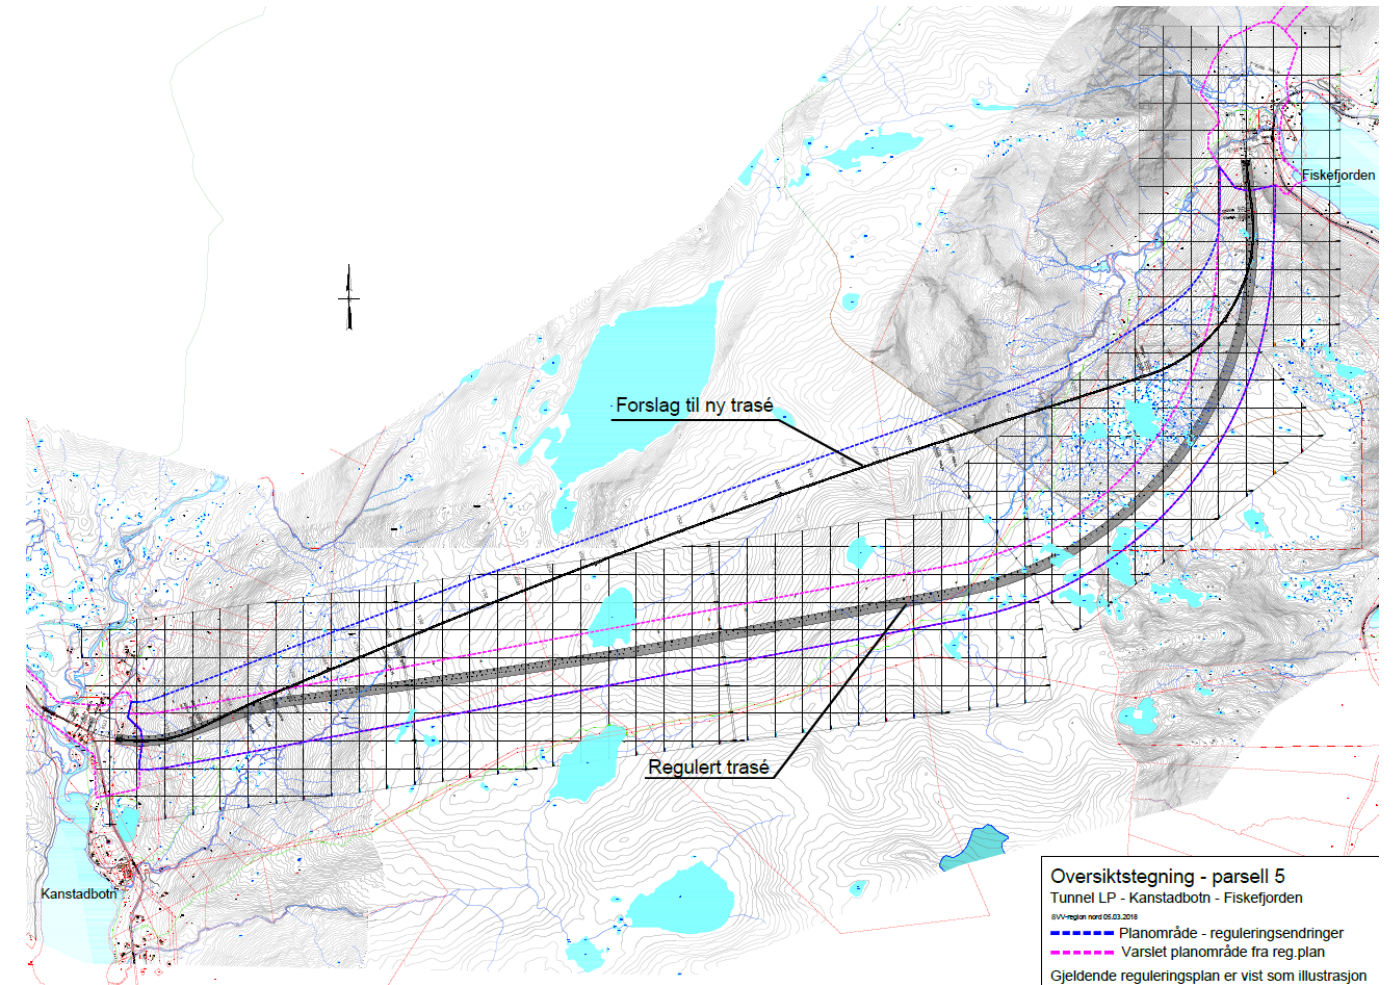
Oversiktstegning plan- og profil fra profil 11250 - 13165.
